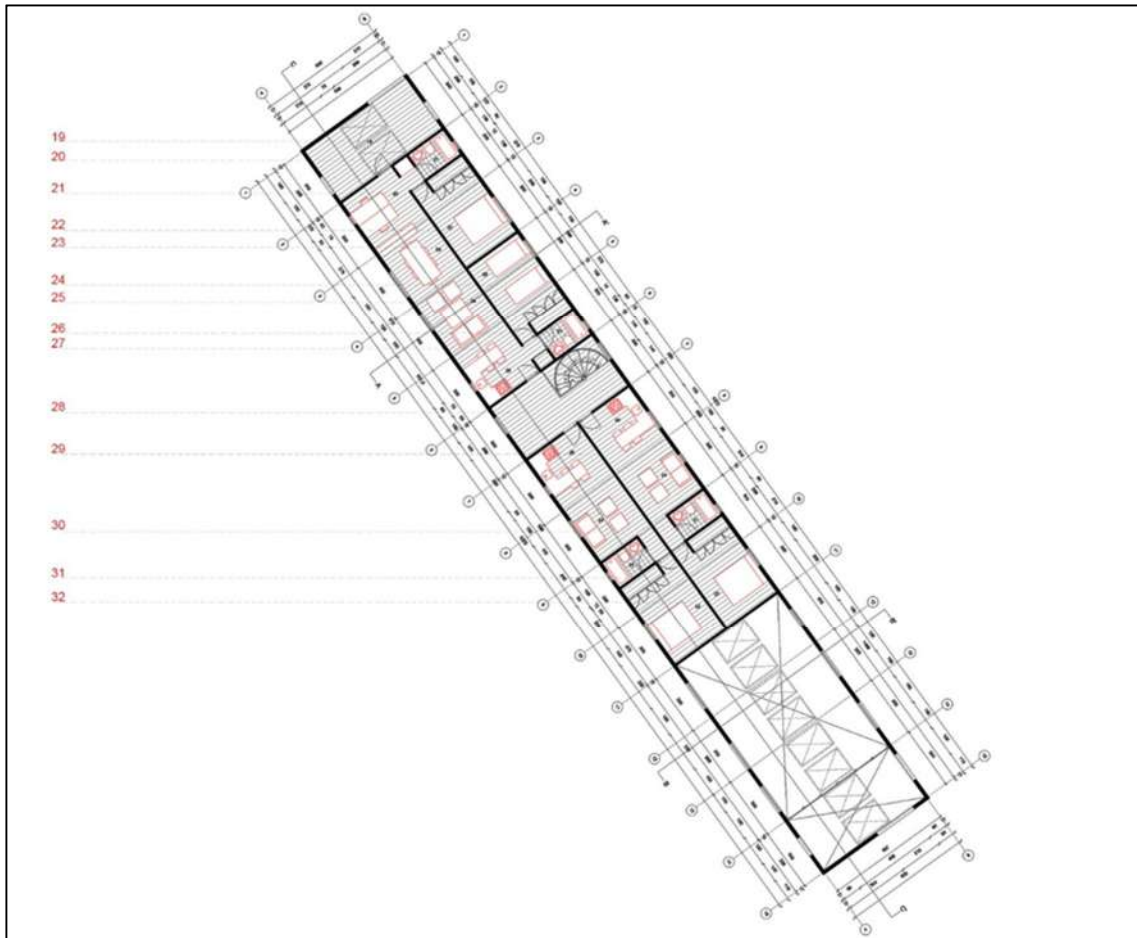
PLANTA NIVEL 2 "PABELLÓN PORTUARIO", ÁREA HABITACIONAL CAPITANÍA DE PUERTO
